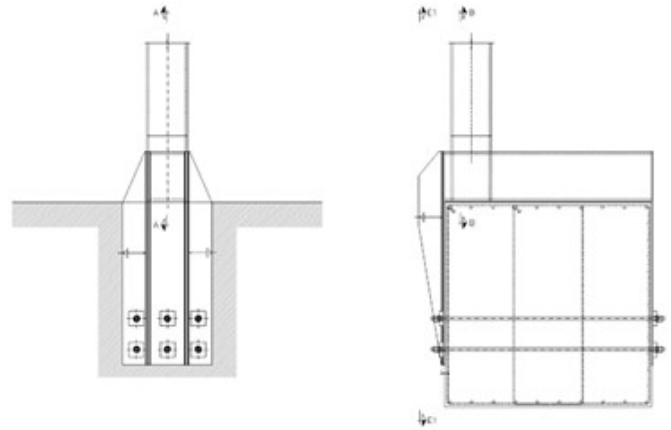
Cimentación apoyos traccionados de muletas fondo norte.
